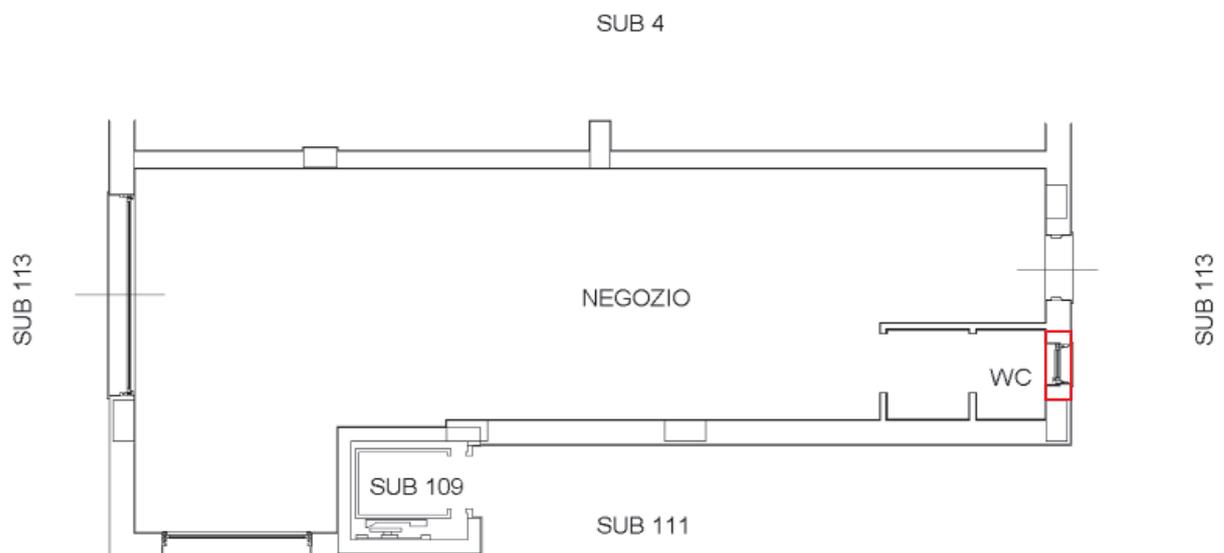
Lotto L7 : Planimetria del locale commerciale sub. 5
